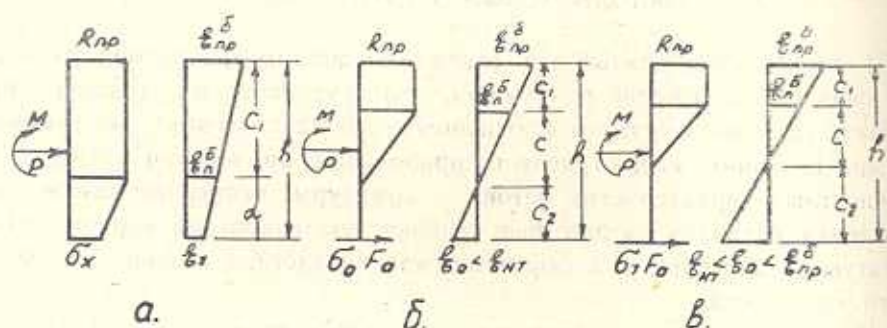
Напряженные состояния внешнетрещотно-сжатого железобетонного элемента прямоугольного сечения: а) I; б) II; в) III.
